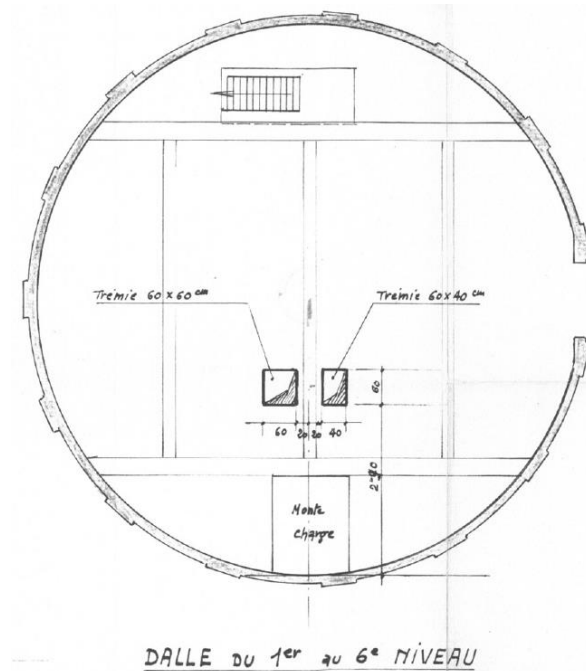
Géométrie du bâtiment Z10 (château d'eau)
